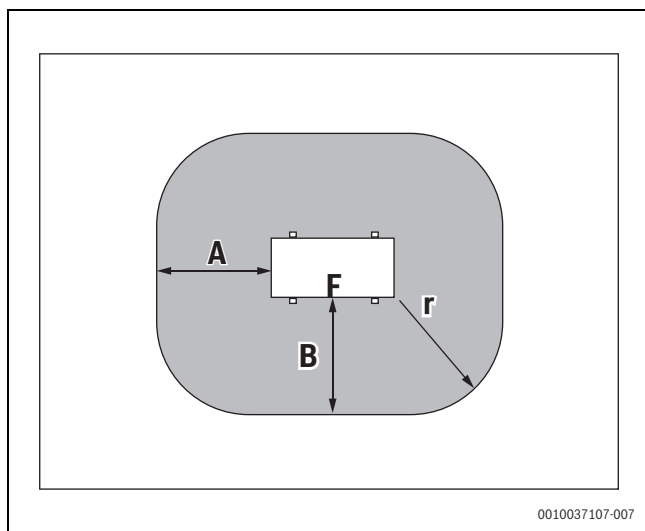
Schutzbereich bei Aufstellung auf dem Boden auf dem Grundstück oder Dach, Draufsicht
